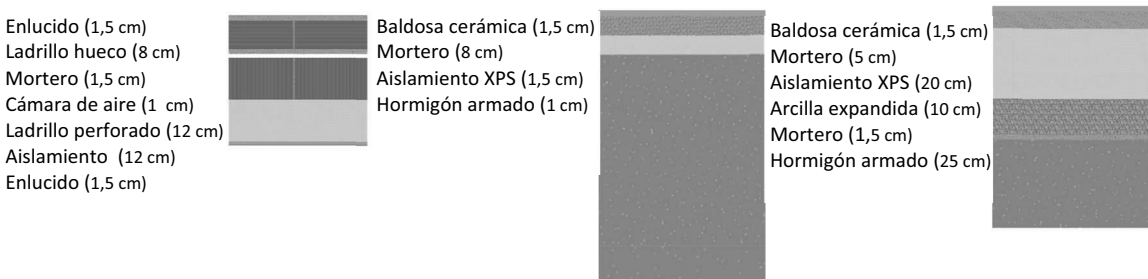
Sección muro tipo, planta sótano y cubierta, respectivamente
